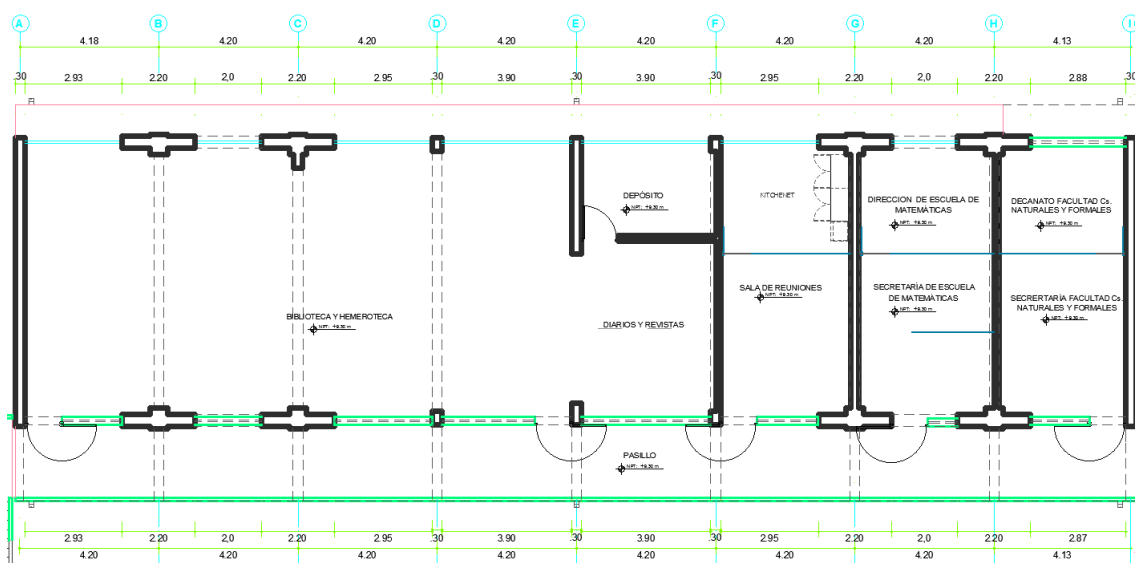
Plano vista en planta – primer nivel (reformulado)
